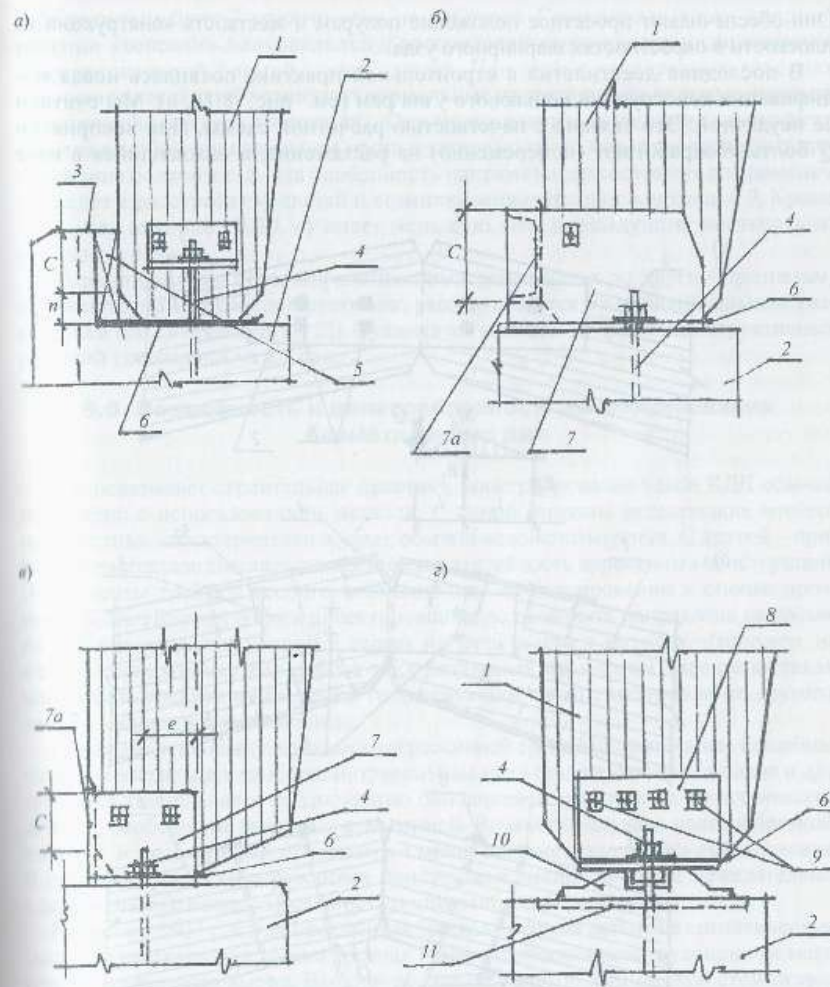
Опорные узлы рам: а – с передачей обеих составляющих опорной реакции на фундамент; б, в, г – с передачей распора на сварные башмаки; 1 – стойка рамы; 2 – фундамент; 3 – армированный выступ фундамента; 4 – анкерный болт; 5 – выравнивающая антисептированная прокладка; 6 – гидроизоляция; 7 – сварные башмаки с упорными столиками 7а; 8 – башмаки из листового материала с передачей распора через болты; 9 – горизонтальные расчетные болты; 10 – балансира шарнира; 11 – закладная деталь
